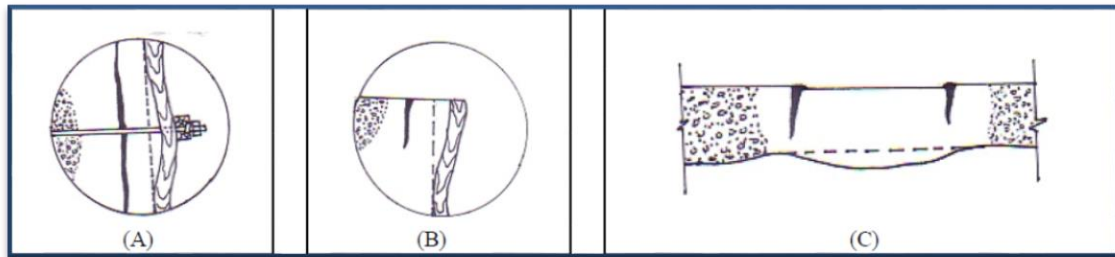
A: La fissure interne du béton est due au déplacement du coffrage [10].
